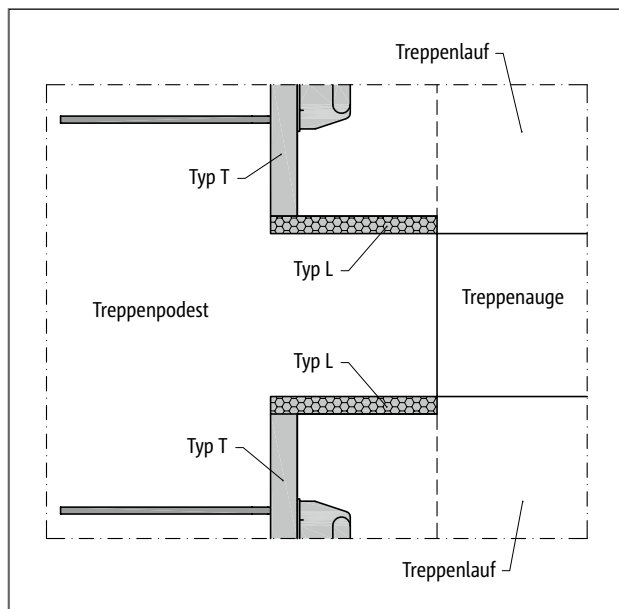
Schöck Tronsole® Typ T: Elementanordnung Detail A
